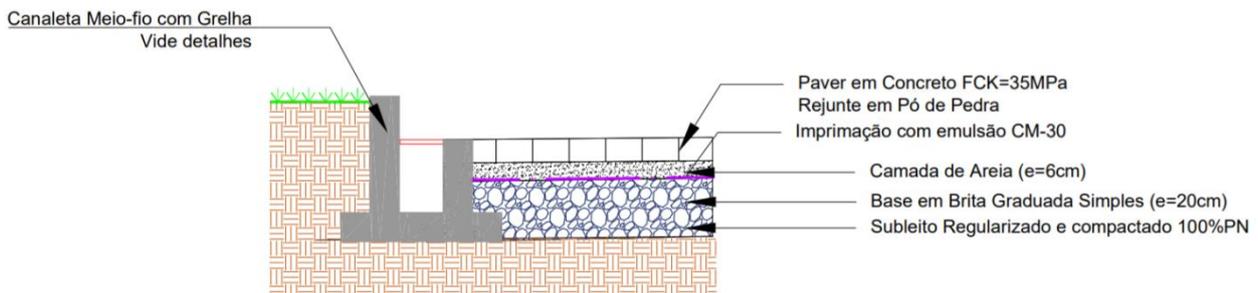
e 33 representam os detalhes de projeto das seções tipo de pavimentação para as áreas de tráfego pesado e leve do pátio de estacionamento.
